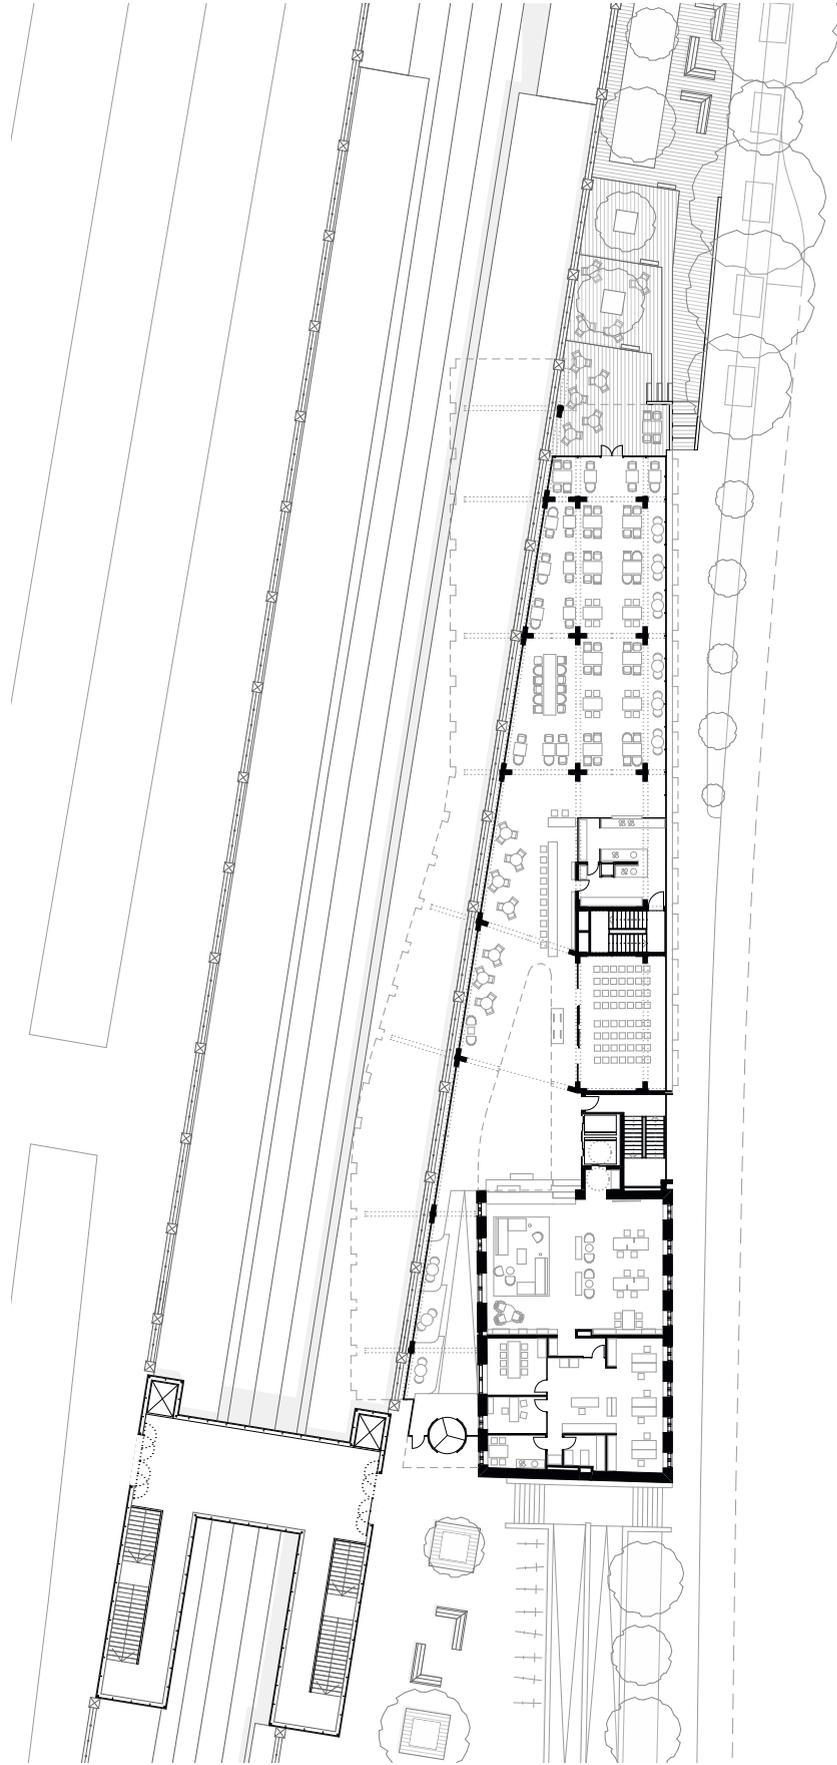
; Grundriss, Erdgeschoß, 1:500
